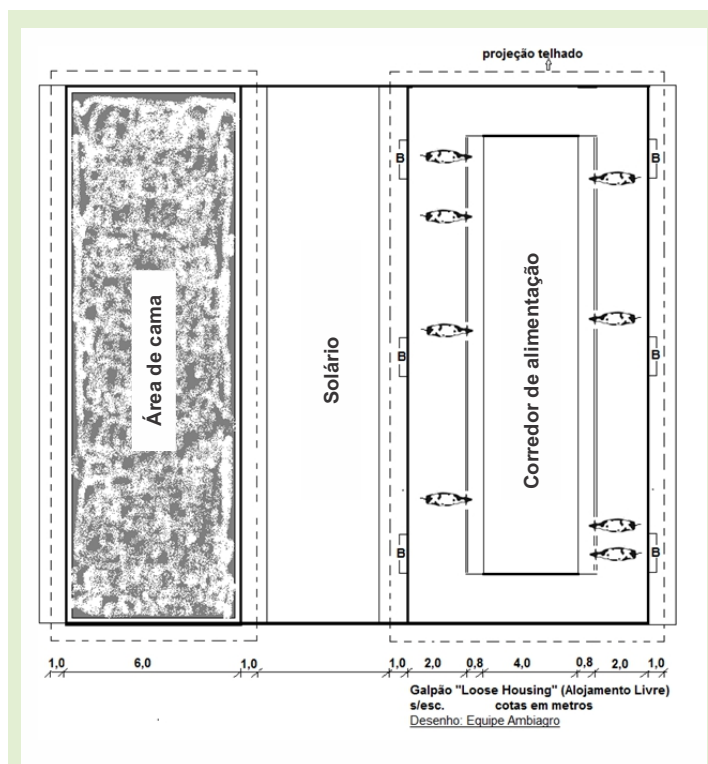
Modelo de planta baixa esquemática de uma instalação do tipo “*Loose Housing*”. (Fonte: Souza et al.⁵).
